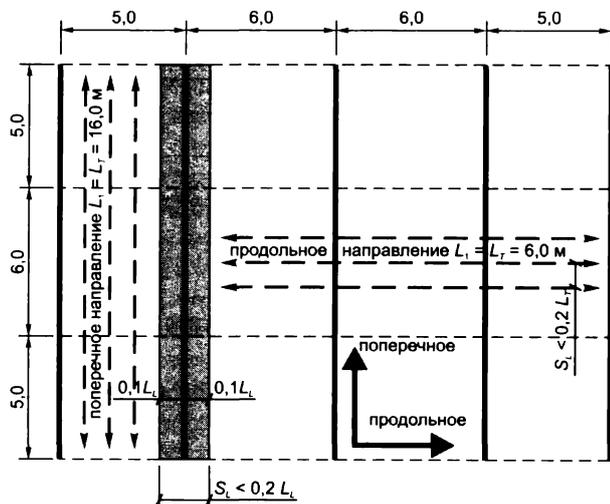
К определению величины расчетных пролетов L_T для зданий с несущими стенами и плитами, работающими в одном направлении (при $H \leq 3$ м — высота этажа в свету) [14]
